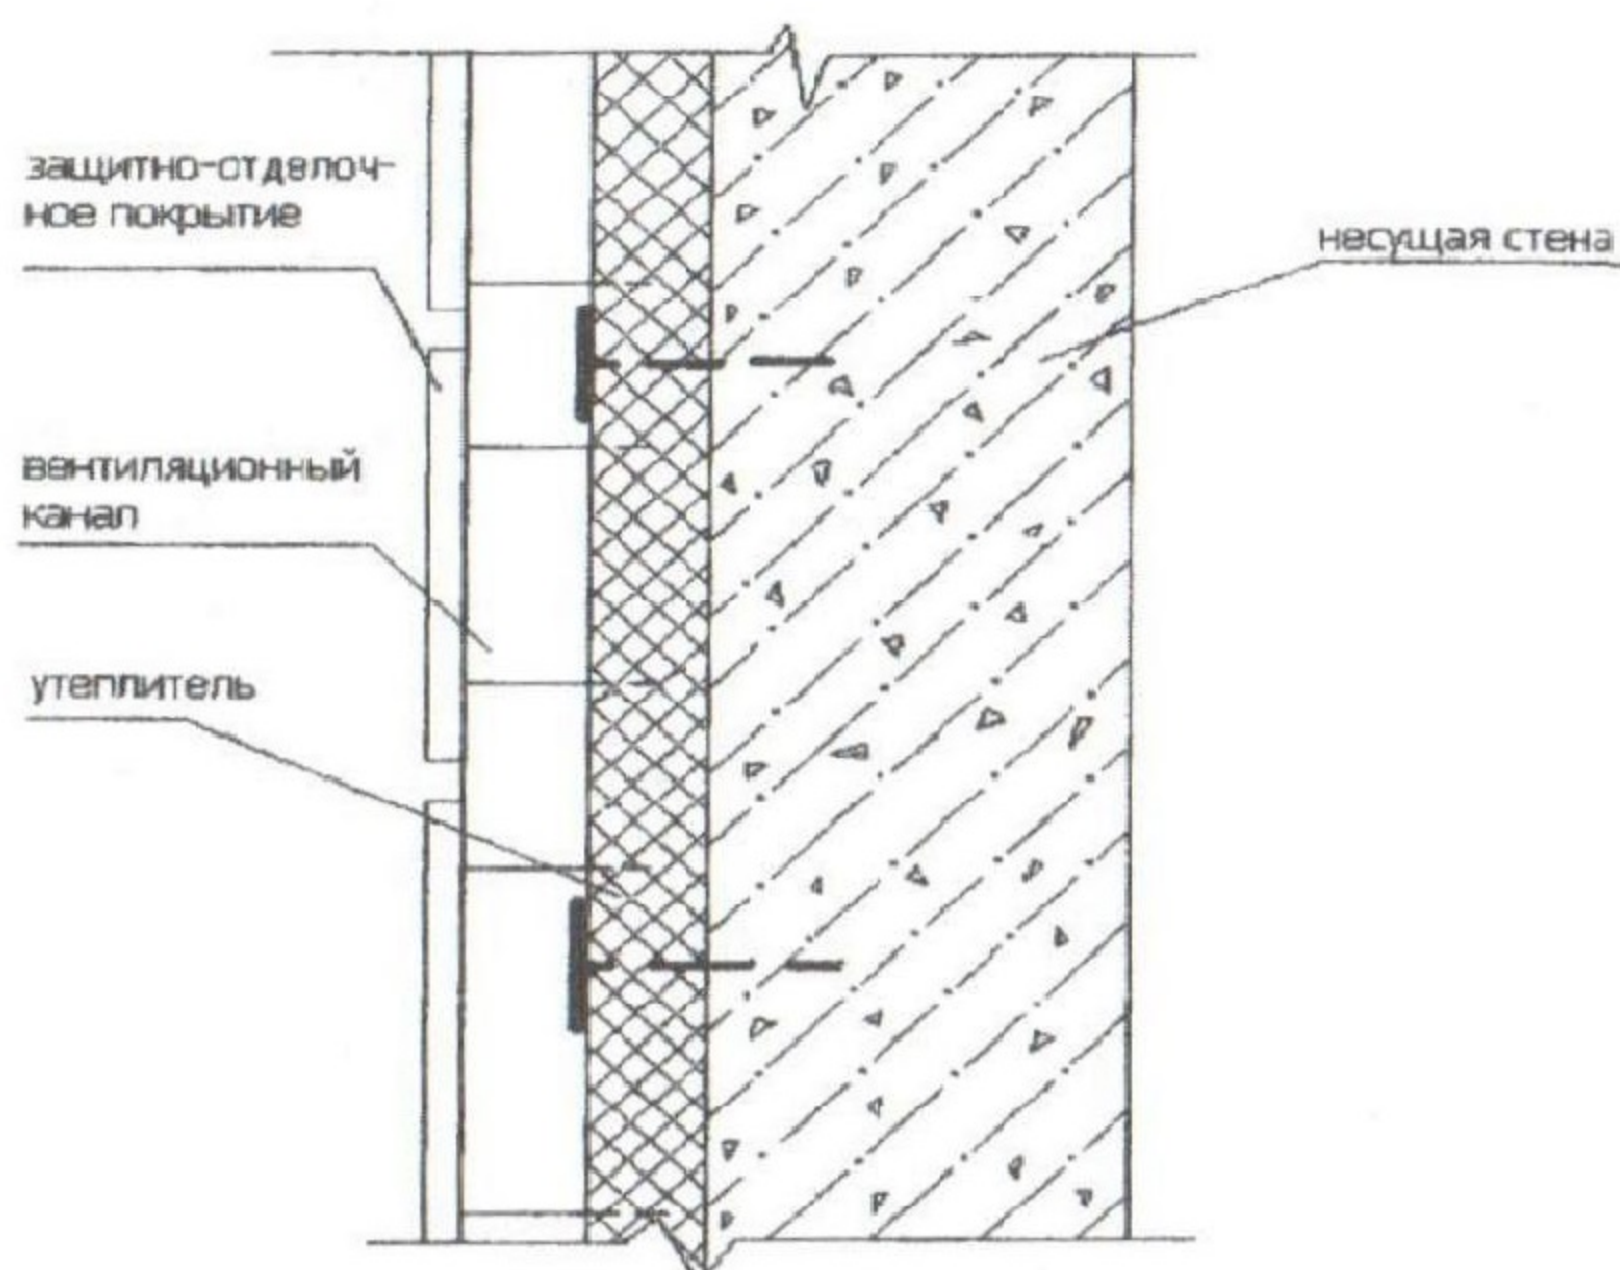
Утепление стен по технологии «вентилируемый фасад».
